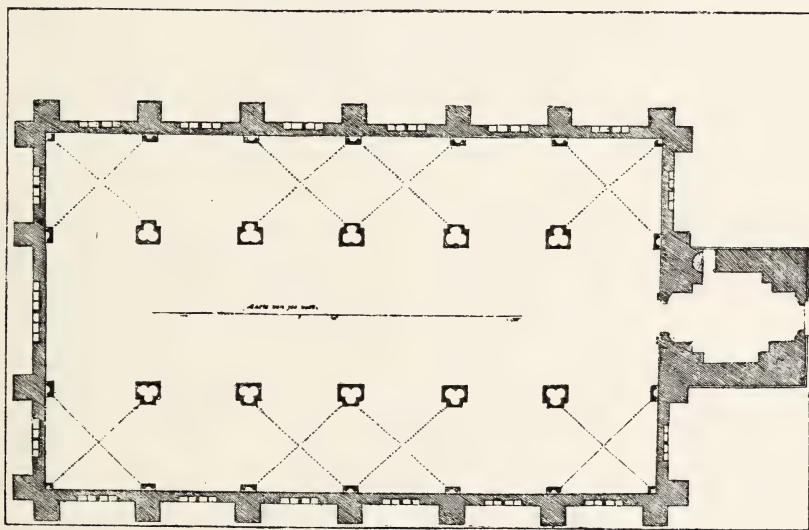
Grundriß. Westerkirche, Amsterdam.
